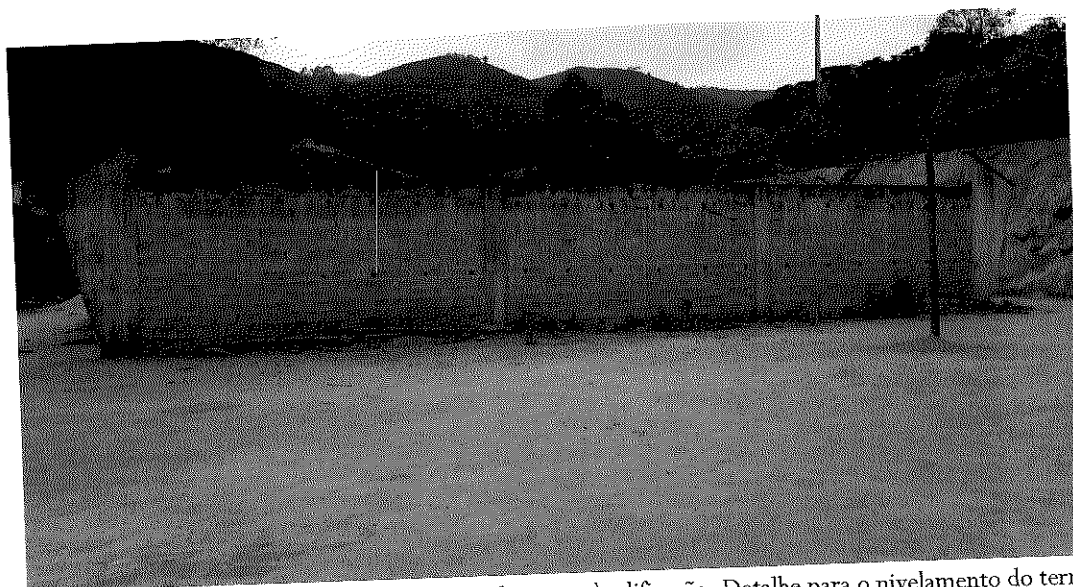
Vista da fachada 04 a partir da rua de acesso à edificação. Detalhe para o nivelamento do terreno.
